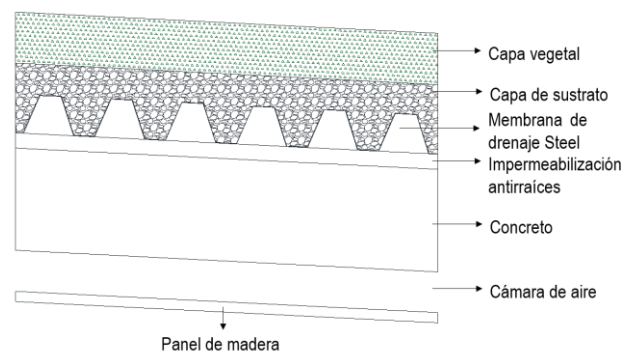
Detalle en 3D de fachada de placa de hormigón con revestimiento en madera
